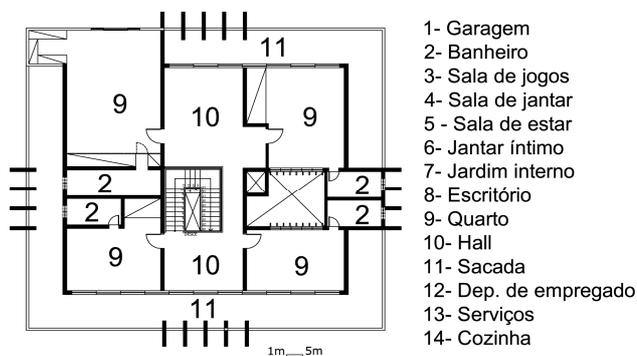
Primeiro Pavimento. Desenho: Rodrigo Queiroz
